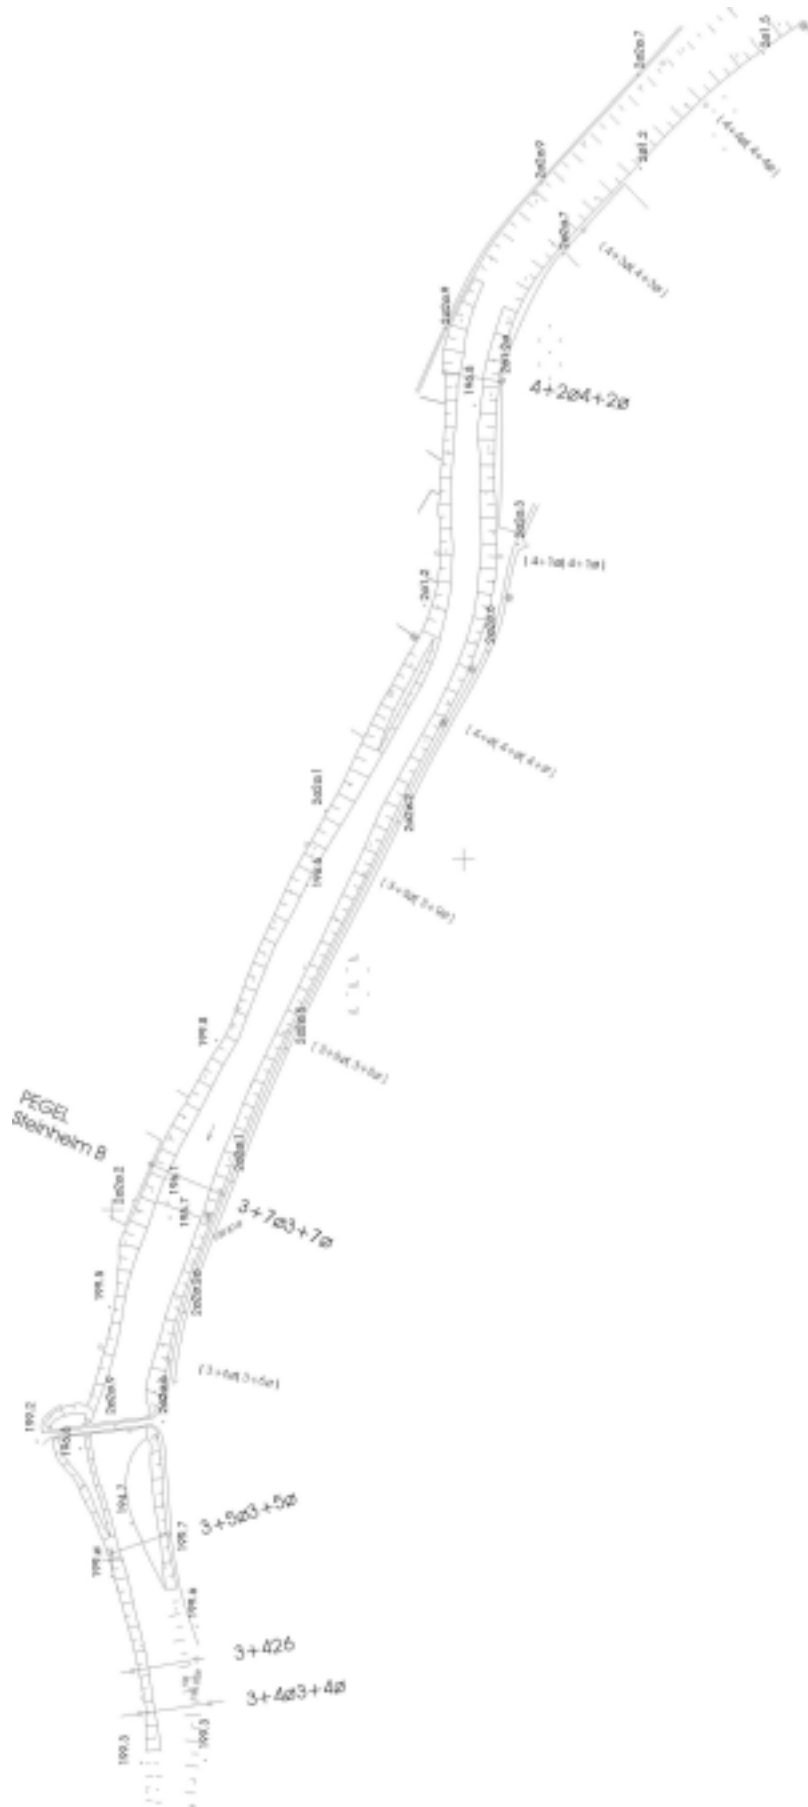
Lage der Profile und Sondermessstellen. Murr-km 3+400 bis Murr-km 4+400.
